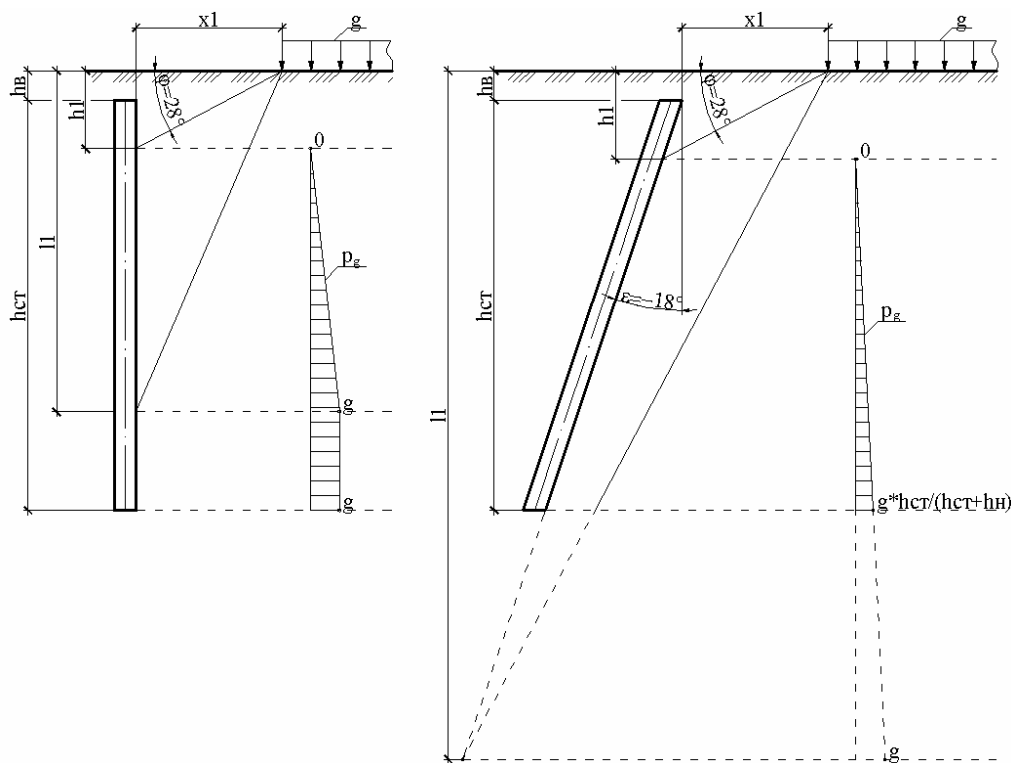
Расчетные схемы для вертикальной и наклонной стенки
